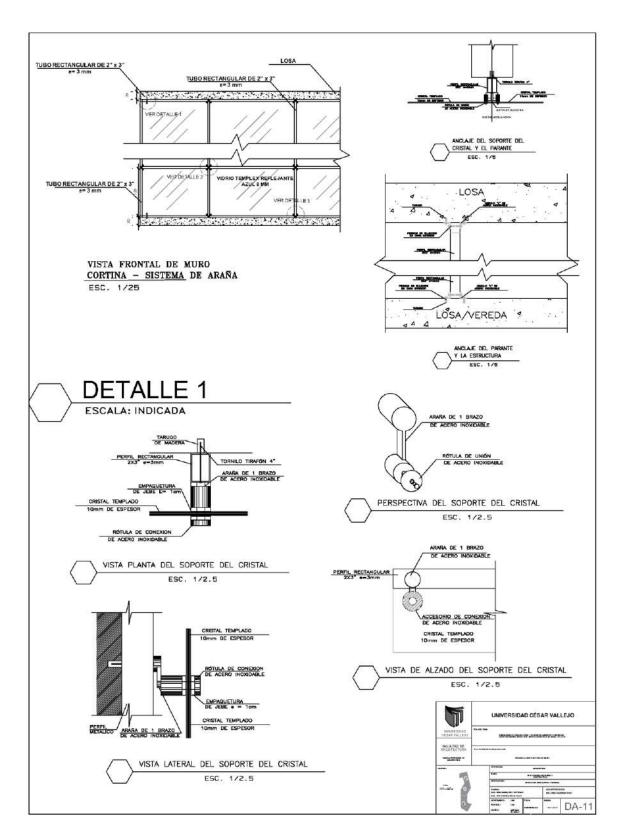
Detalle de muro cortina - DETALLES ARQUITECTÓNICOS
